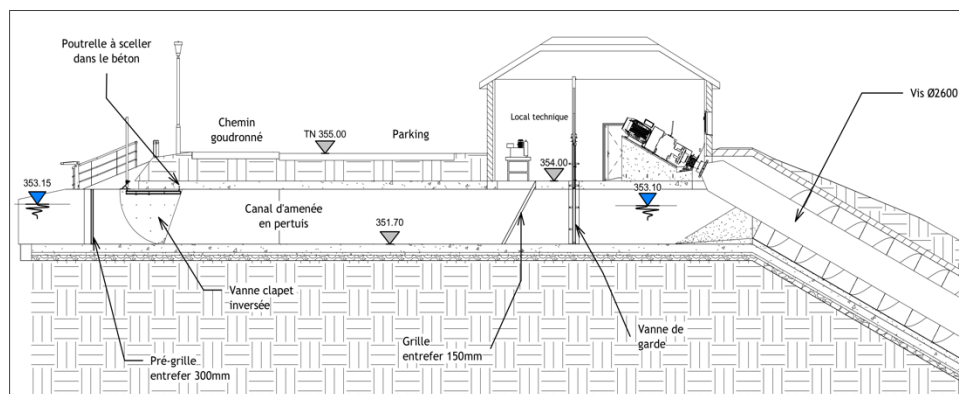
Vue en coupe du canal d'amenée de la future centrale
